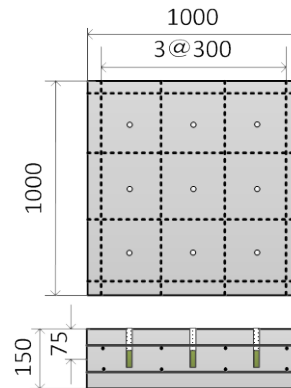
コンクリート版試験体 (鉄筋比 0.32%)
